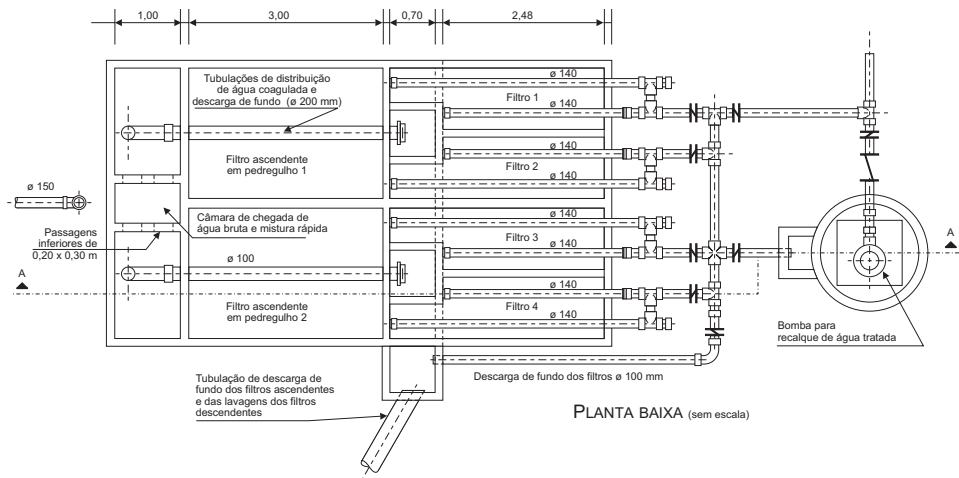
Planta baixa da ETA de dupla filtração para abastecimento industrial.
